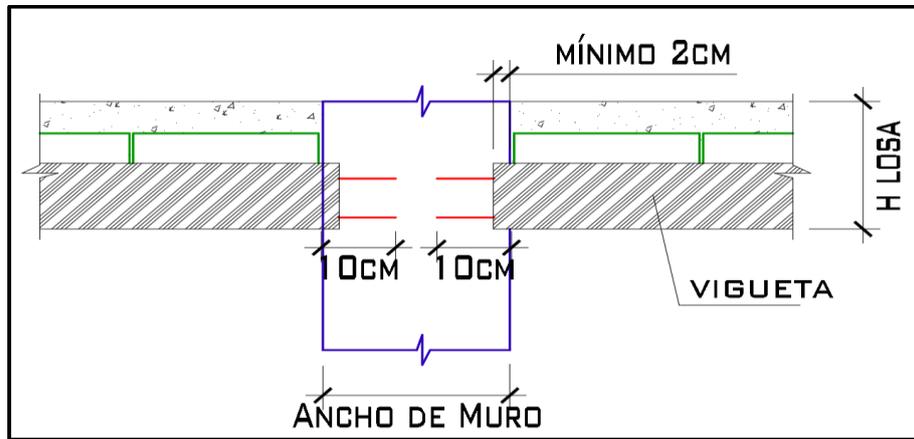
Detalle de ingreso de vigueta a placa con alambres vistos apoyo continuo.
